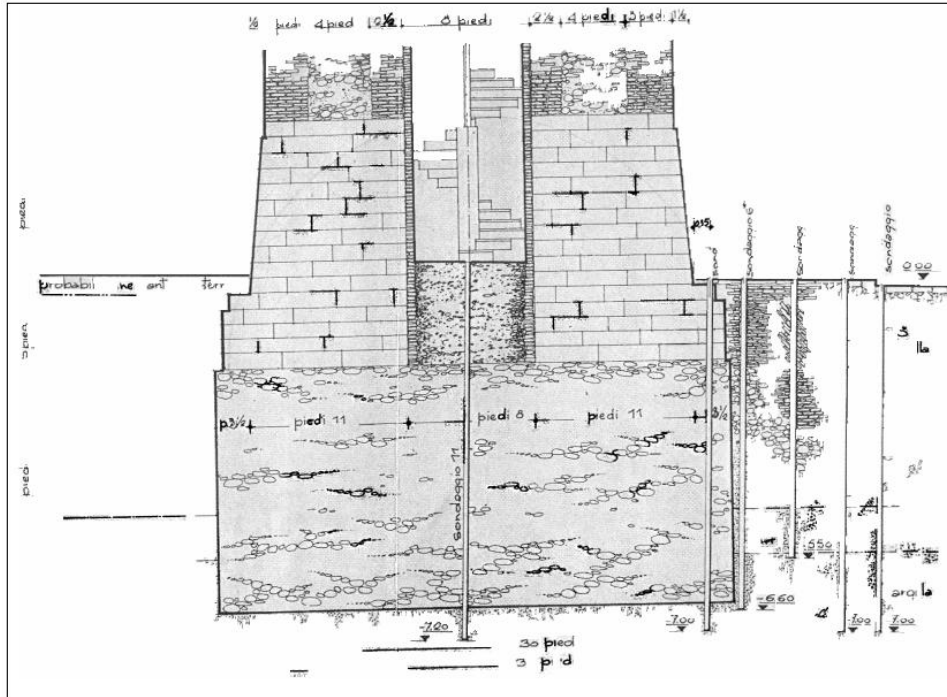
Sezione schematica della fondazione della Torre degli Asinelli, in seguito ai carotaggi del 1974 (Traversa, 2011).
